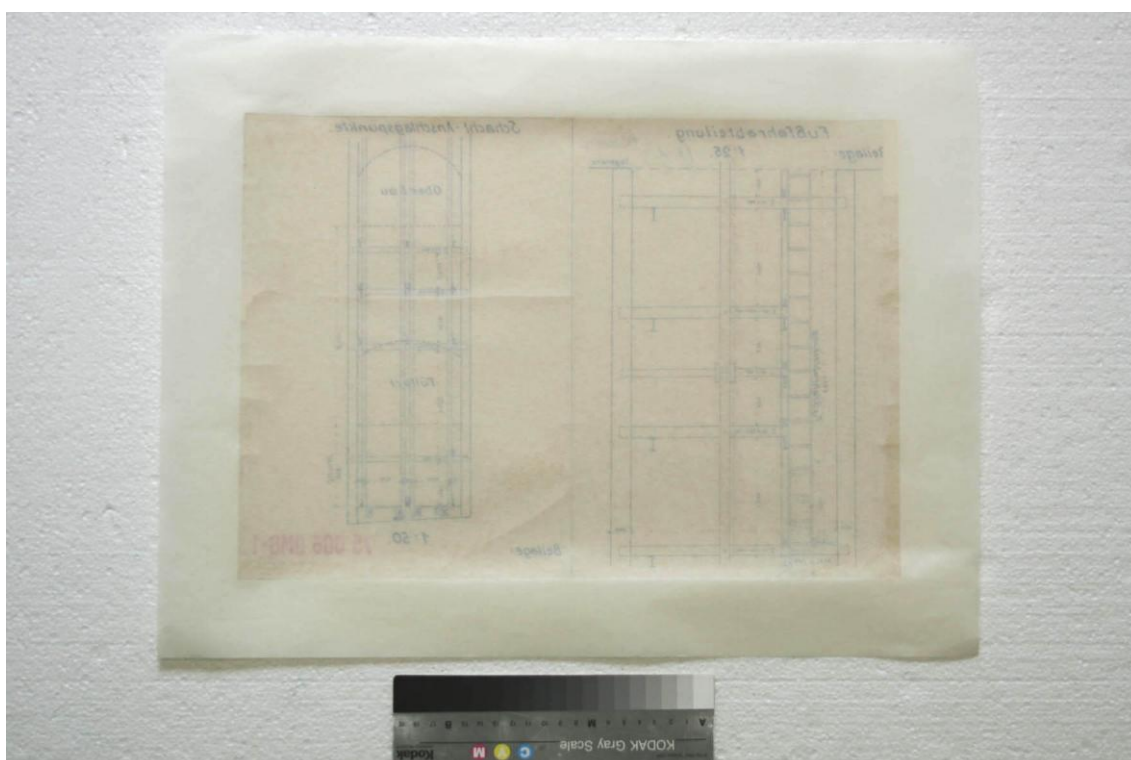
Stav v průběhu restaurování, detail poškození po vyčištění a vyrovnání.
